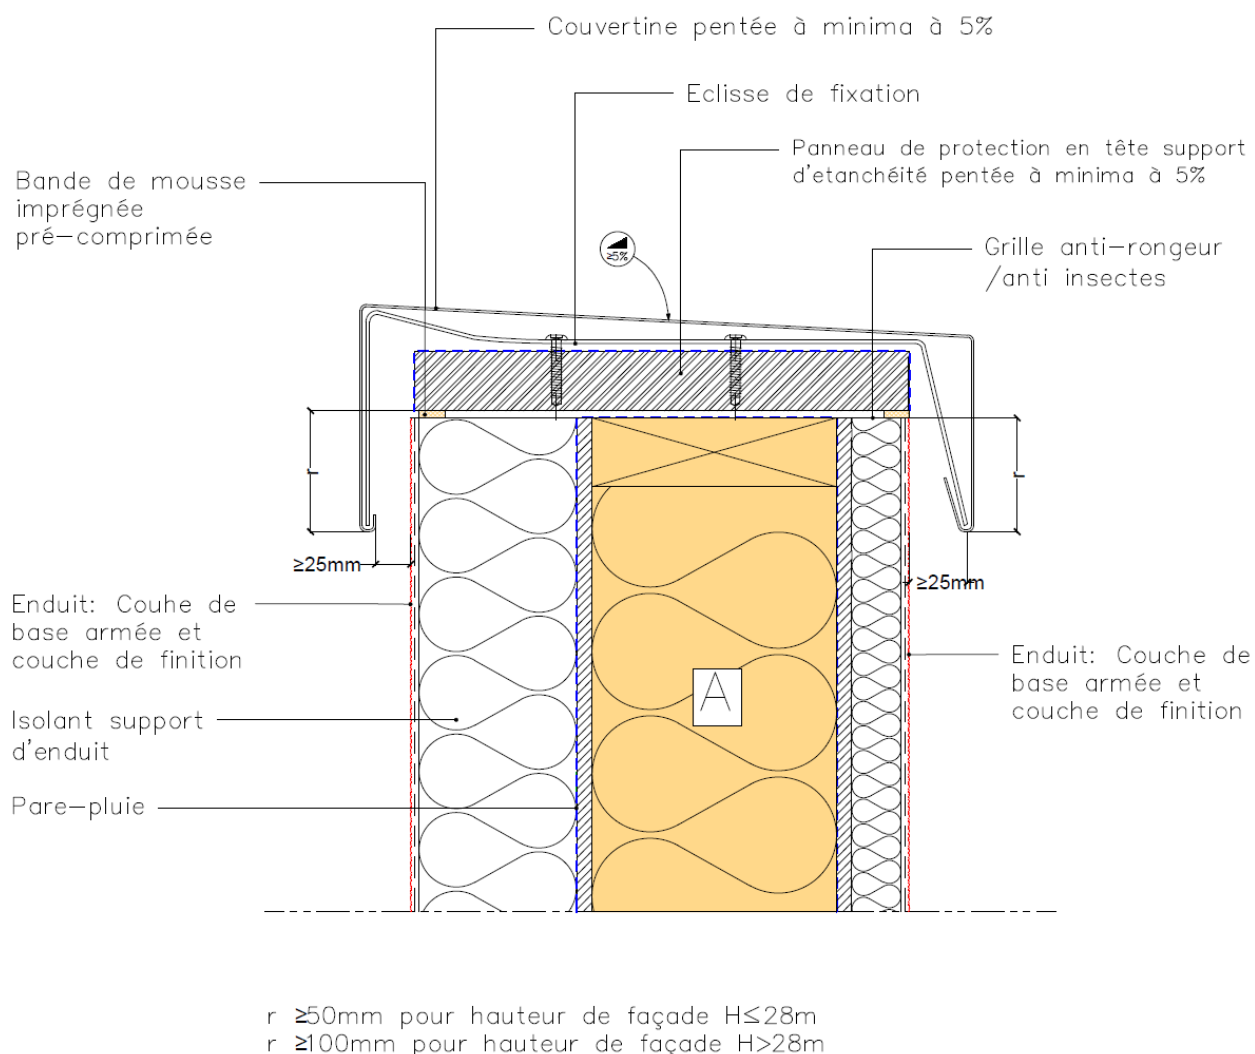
Toiture terrasse - Acrotère - ETICS côté toiture - Coupe Verticale
